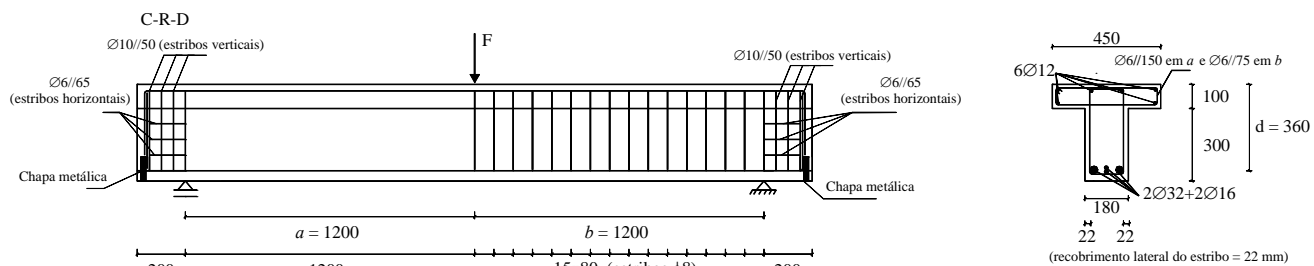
Geometria das vigas da série D (dimensões em mm).
